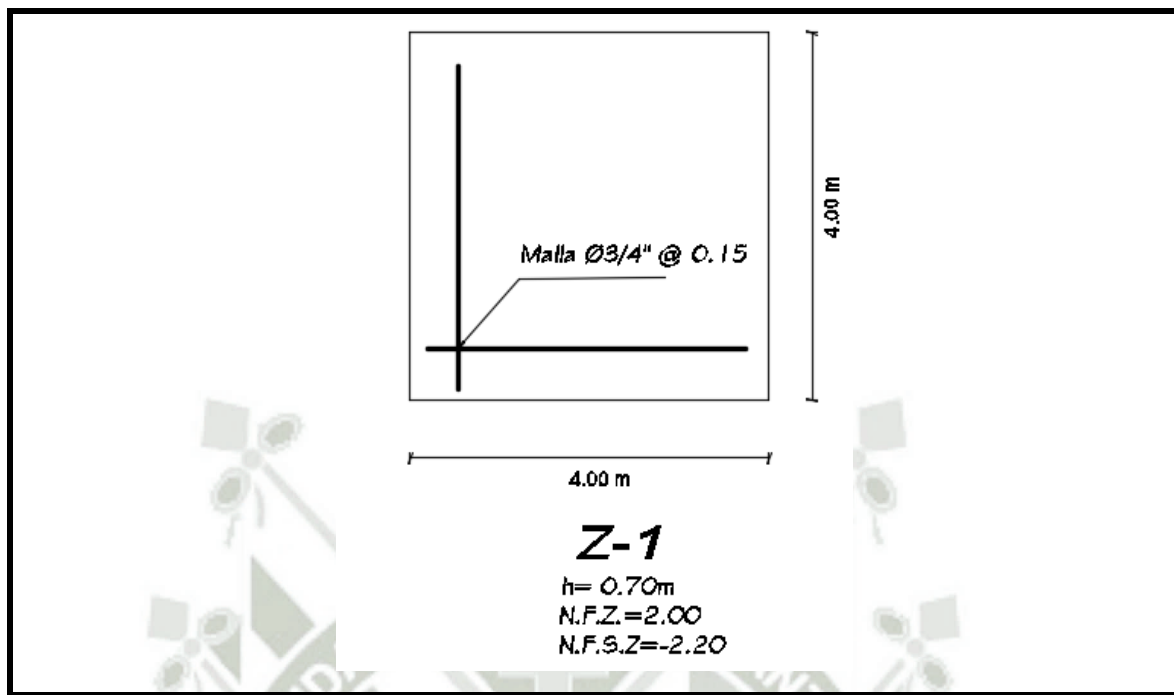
A: Diseño final sección en planta (Z-1).
